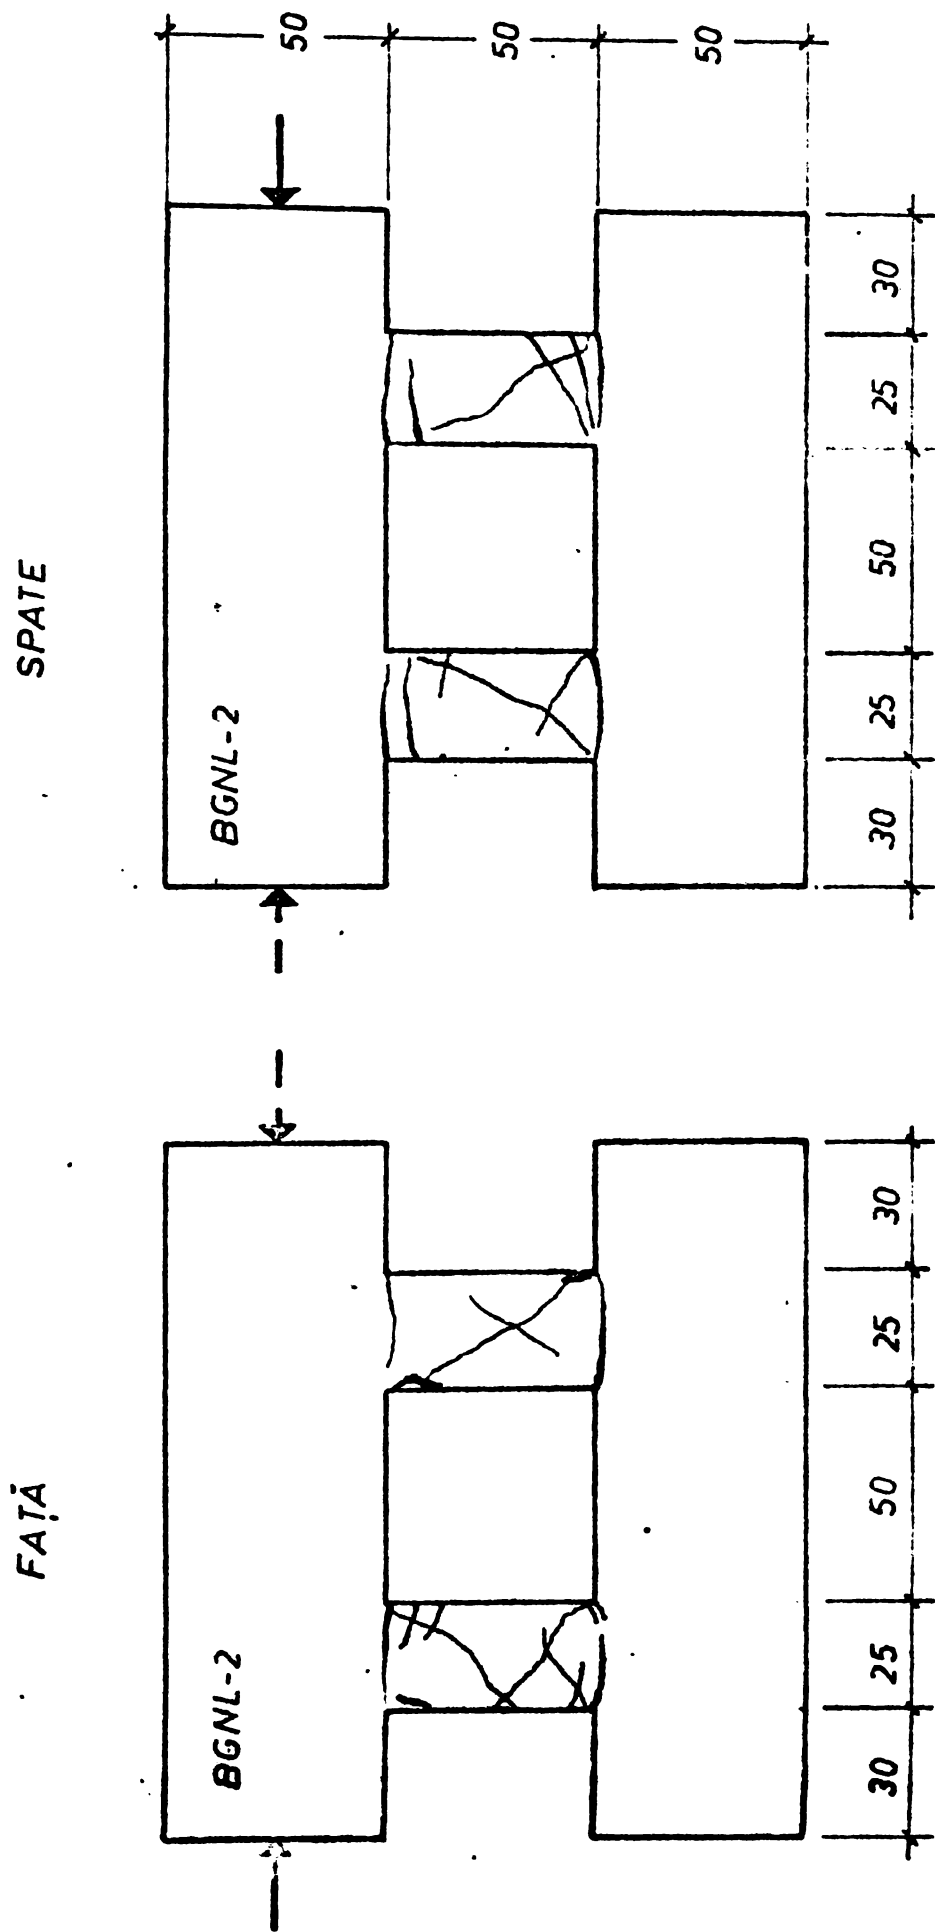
MODUL DE FISURARE A BUIANDRUGILOR ELEMENTULUI BGNL-2 LA RUPERE
